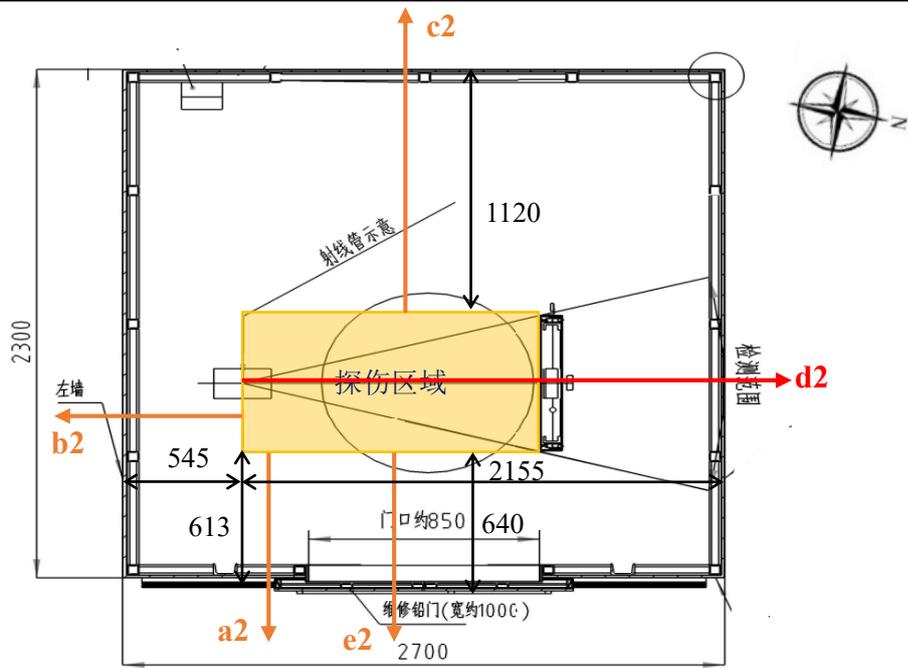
辐射屏蔽计算预测点位平面图（永久路厂区）（单位：mm）
